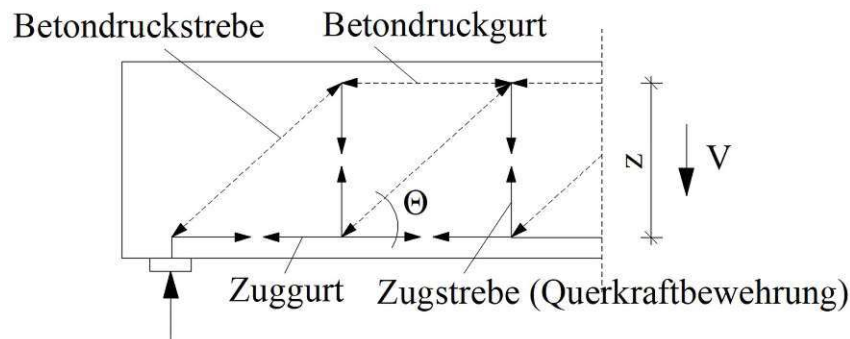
Fachwerkmodell zur Beschreibung der Lastabtragung von Querkraften in Betontragwerken vgl. [27]
